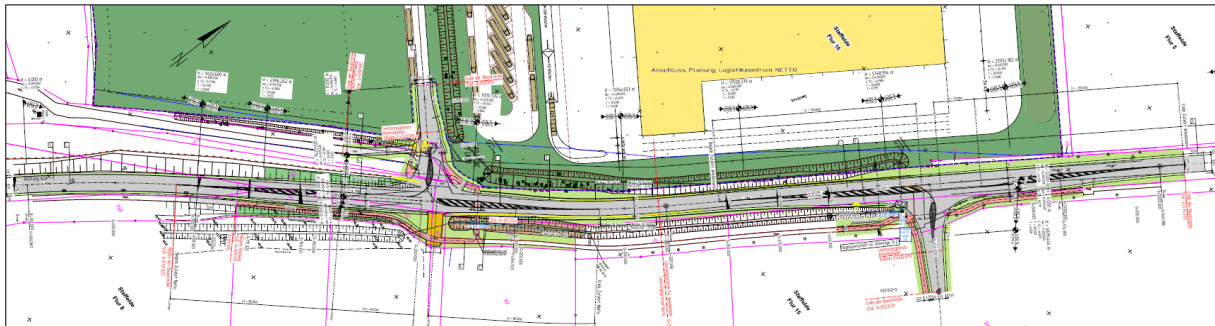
Ausschnitt Lageplan zur Entwurfsplanung, Ingenieurbüro Weiland (Stand 22.11.2022)
